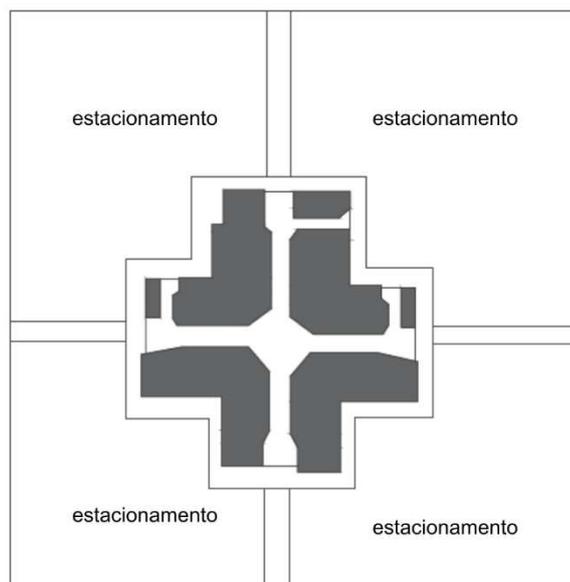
Planta esquemática do *Lakehurst Shopping Center
